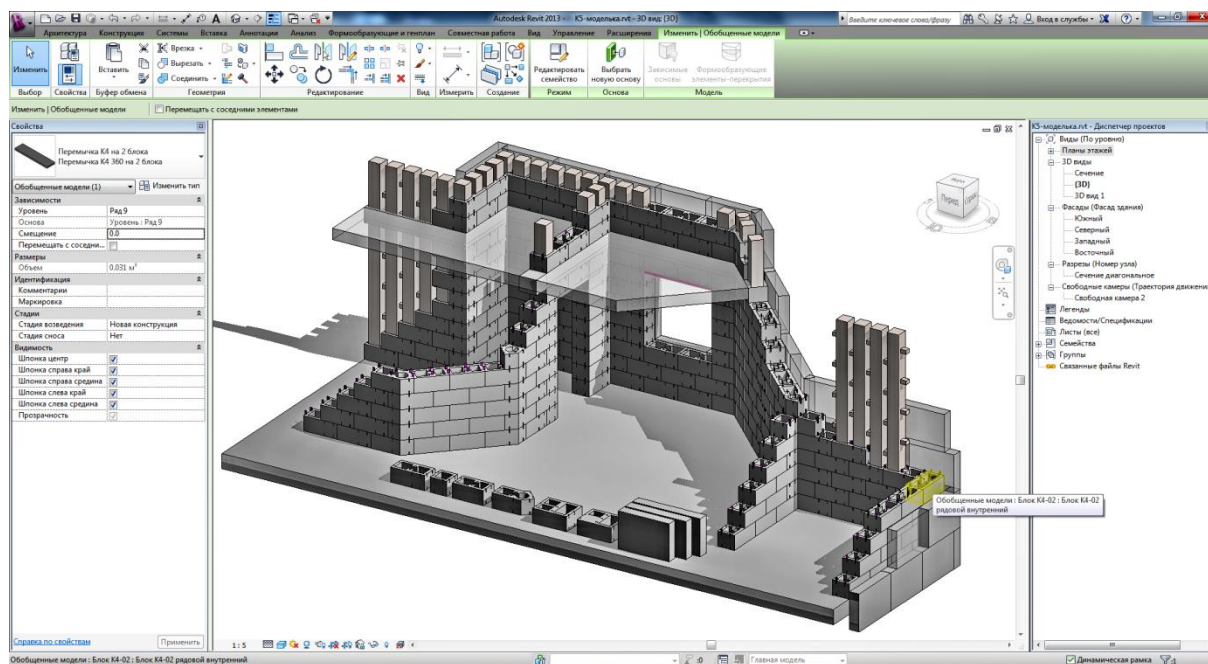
Иллюстрация кладки из блоков; формирование колонн, проемов, утепление фасада.
